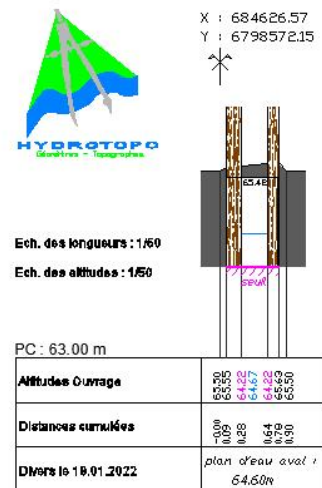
Vue en coupe de l'ouvrage exutoire du plan d'eau de « La Nosaye » (OH61)
